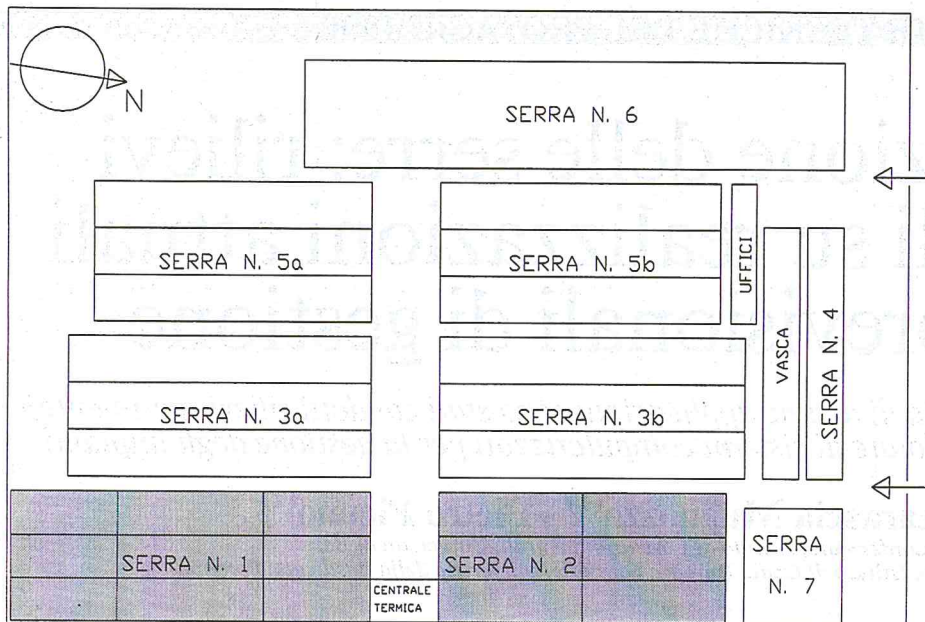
Disposizione planimetrica del complesso serricolo.
